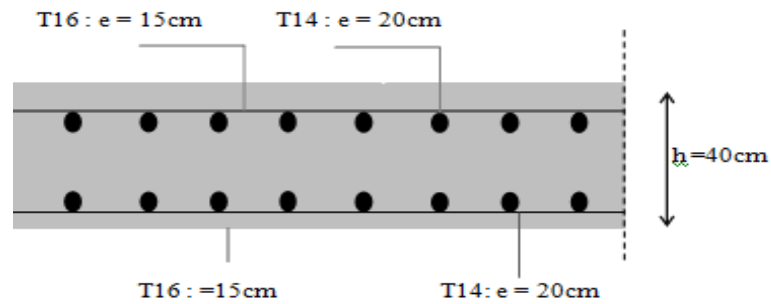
Ferrailage de la dalle du radier sens x-x
